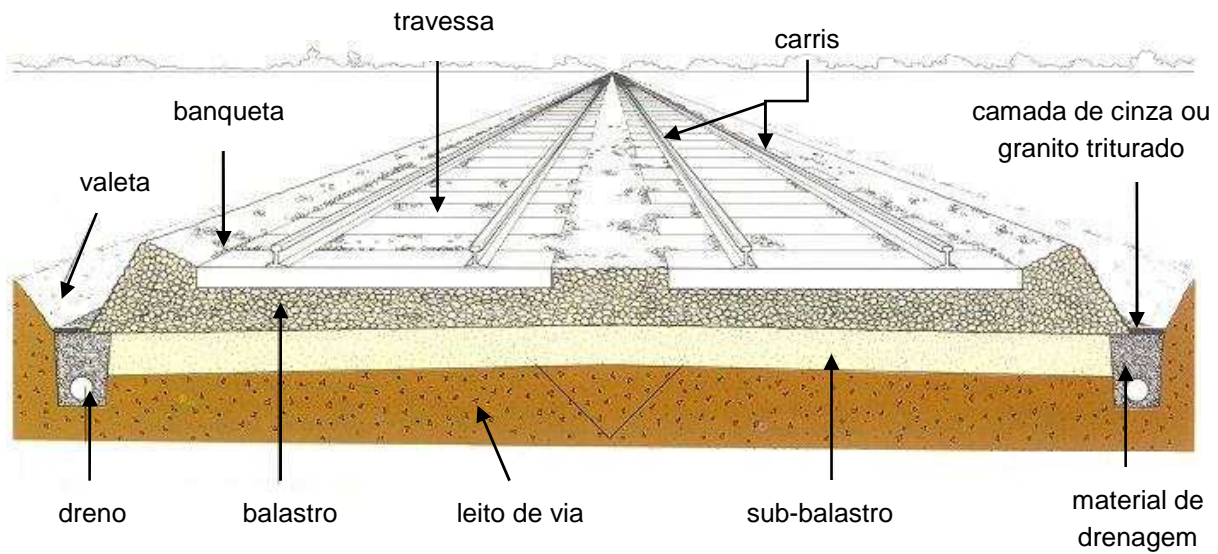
Secção transversal da via férrea em balastro (adaptado de TodoTren, 2007)
